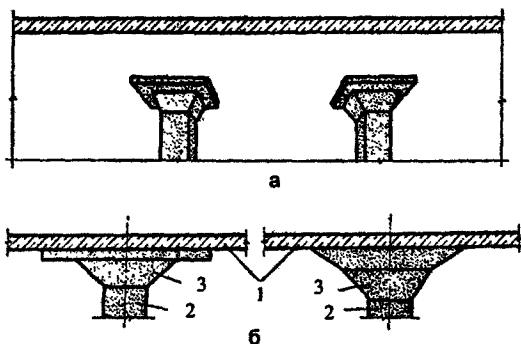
Безбалочное железобетонное монолитное перекрытие:
